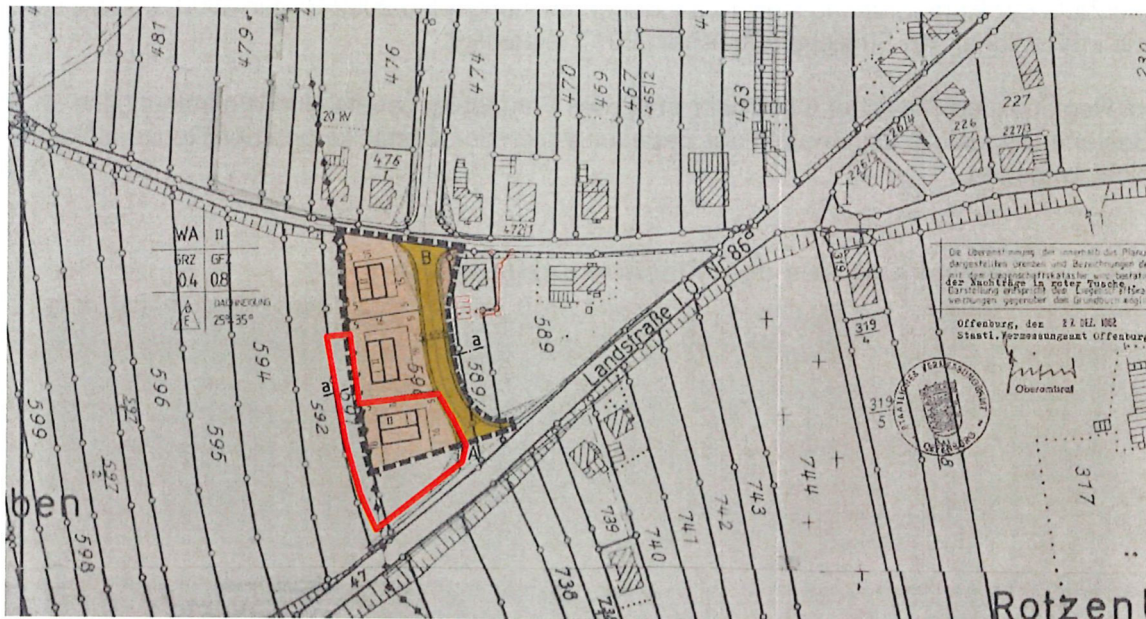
Ausschnitt des Bebauungsplanes "Westtangente Süd" aus dem Jahre 1982; Quelle: Ingenieurbüro Zimmer Lauf, eigene Darstellung
